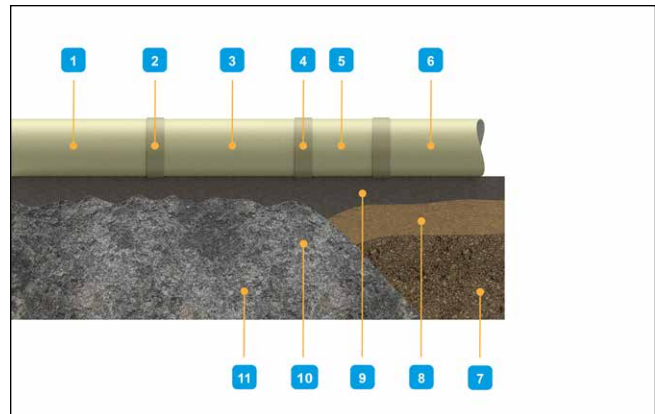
Спосіб будівництва траншеї та розташування труб на переході «порода-ґрунт» 1
